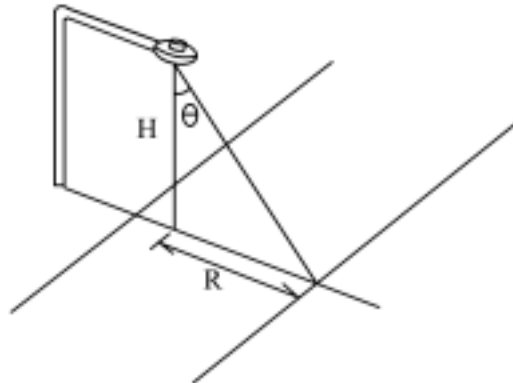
Plano de la calle y colocación de postes propuesta.
